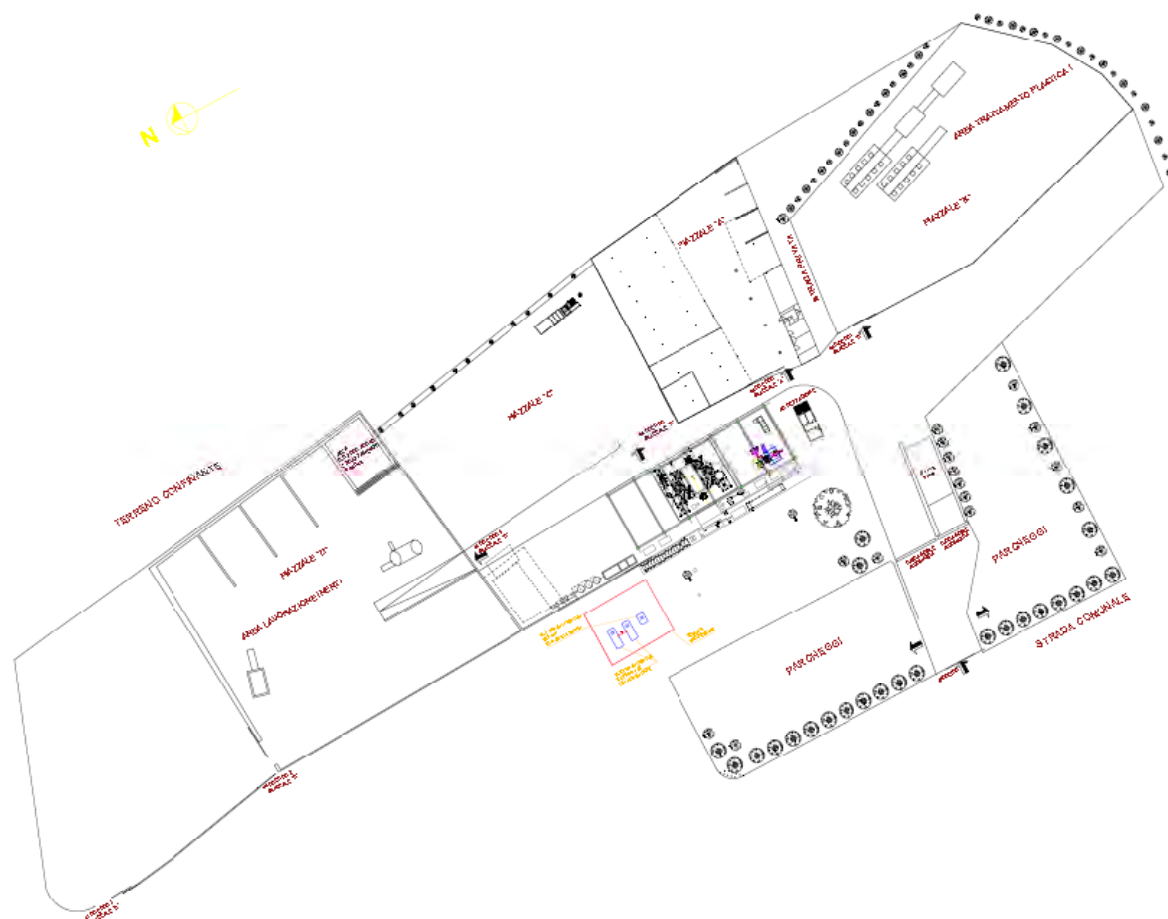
Planimetria generale di insieme del sito di Loc. Pontevecchio, della Radi Srl.
